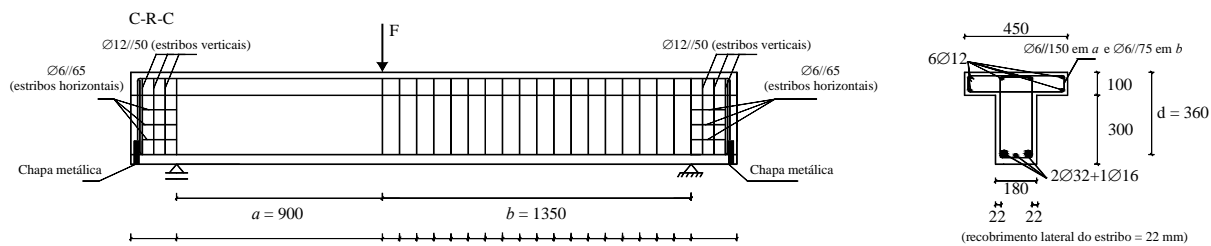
Geometria das vigas da série C (dimensões em mm).
